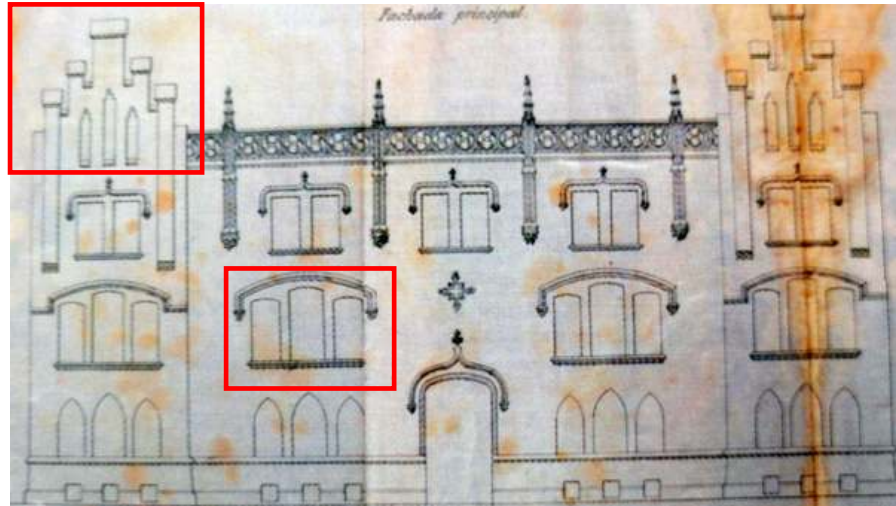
y 85.- Alzado y vista de la fachada principal. "Demetrio Ribes". I. Aguilar.
